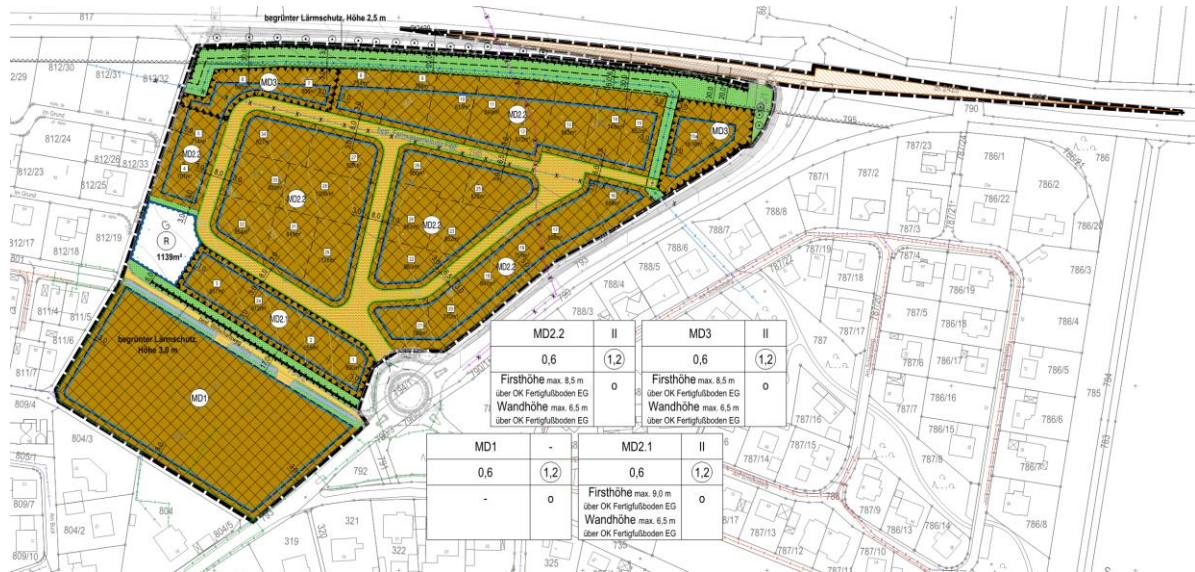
Bebauungsplan „Schlossgrund“, Planteil mit Nutzungsschablone, Stand 10.07.2018
